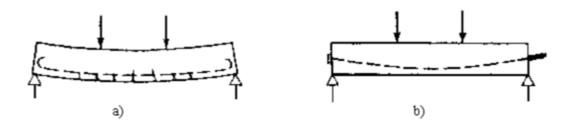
(j). Viga de concreto fuente en página www.ingenieriacivil.cjb.net
